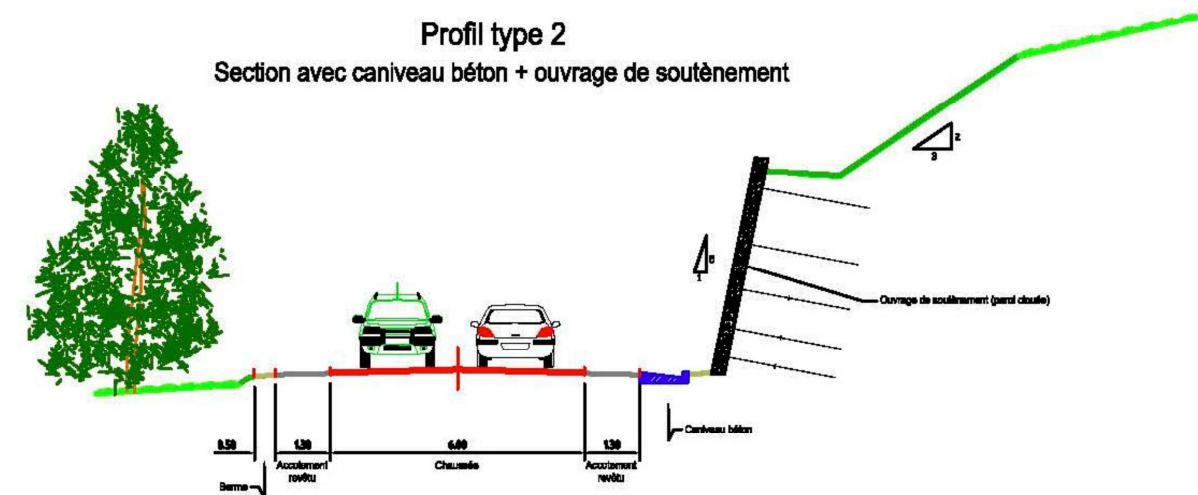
Profil en travers avec caniveau bétonné et paroi clouée
